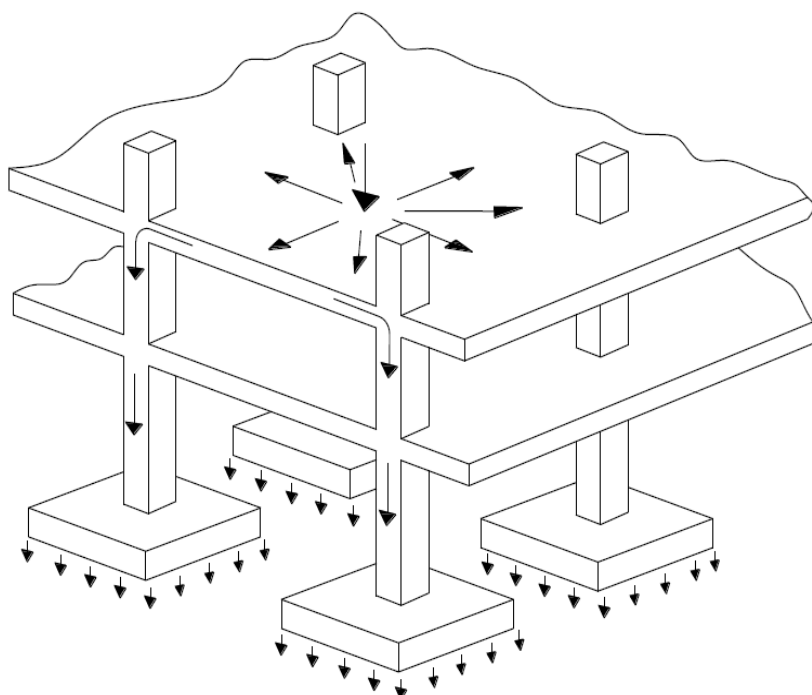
Modelo icónico de uma laje maciça (fonte – Trindade 2009)
